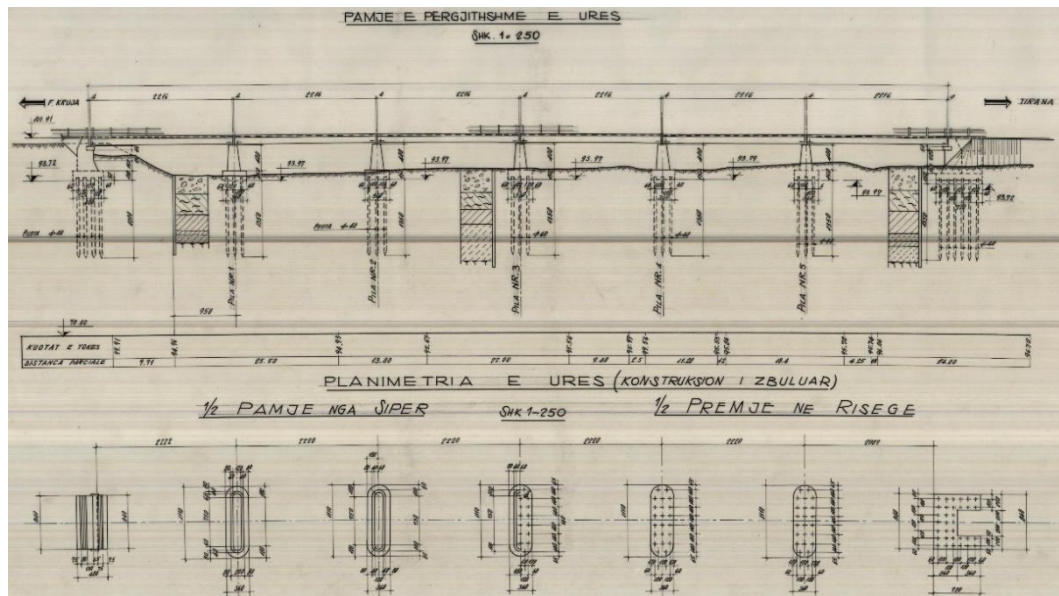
Profili gjatësor dhe planimetria e nënstrukturës (Shkëputur nga projekti fillestar)
